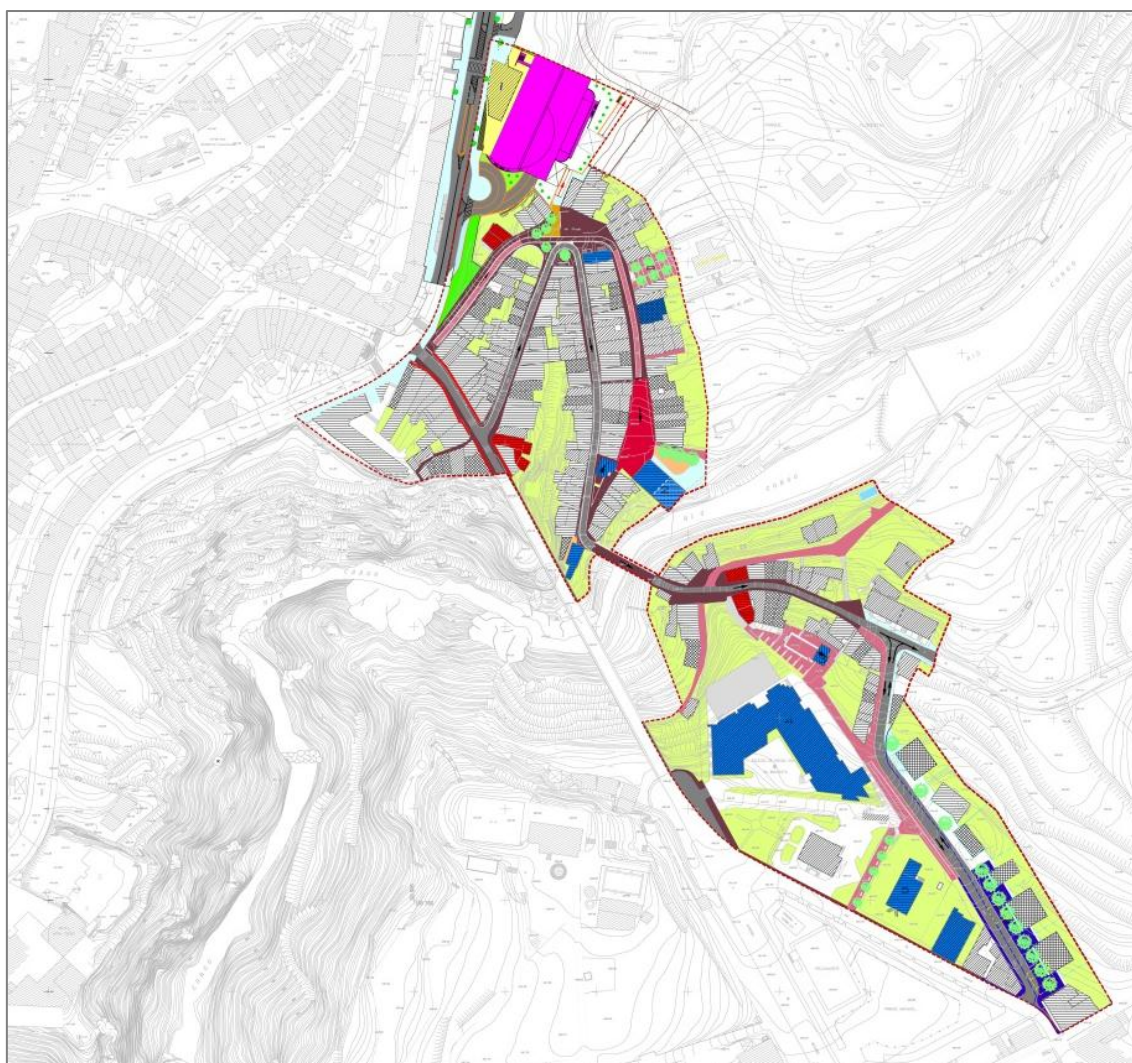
Extracto da Planta de Implantação do PPBF e Legenda (2ª versão – 2011)
